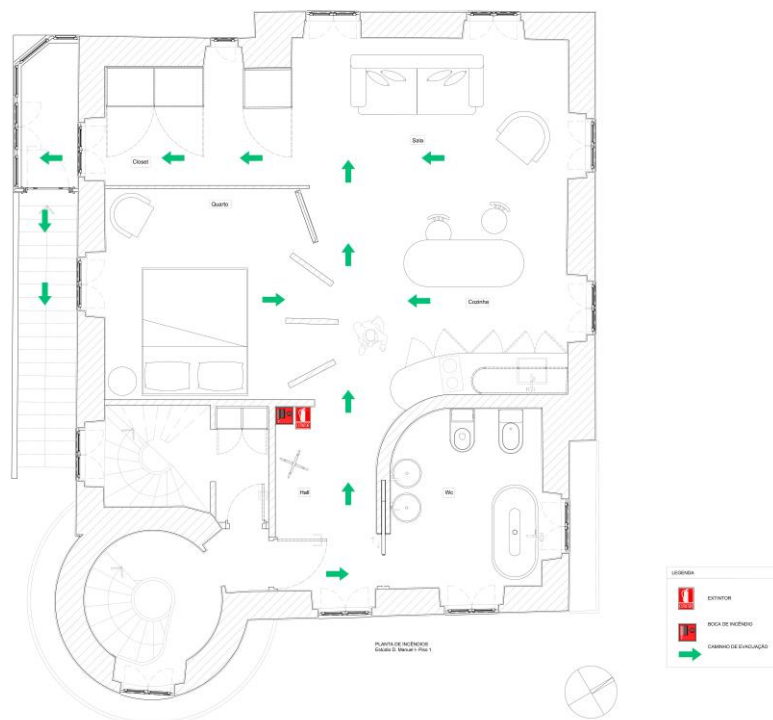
Planta de Incêndios- Estúdio D. Manuel I; Fonte: Beatriz Cordeiro
